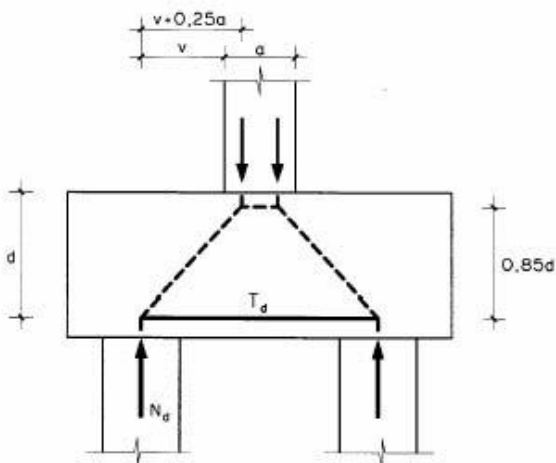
Modelo de bielas y tirantes para el cálculo de pilotes²⁹
